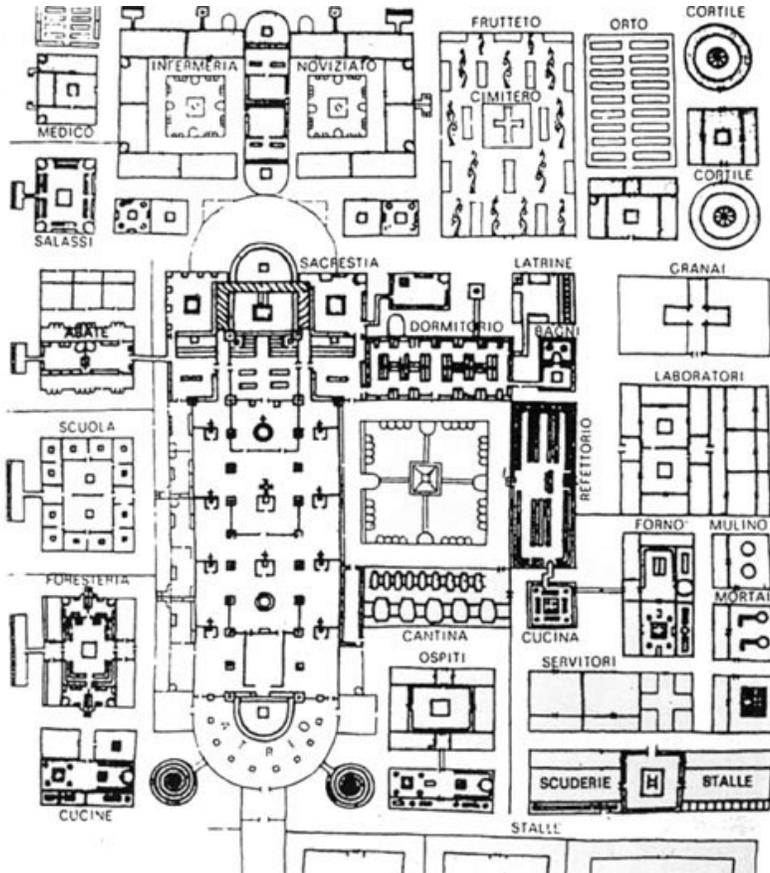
Planimetria generale dell'Abbazia di San Gallo (820 c.).
